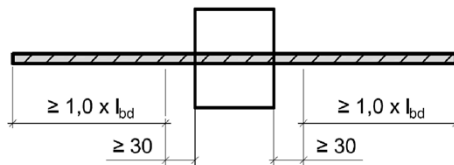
Horizontalstab gerade für Schöck Isokorb® Typ H-NN, Aufsicht
